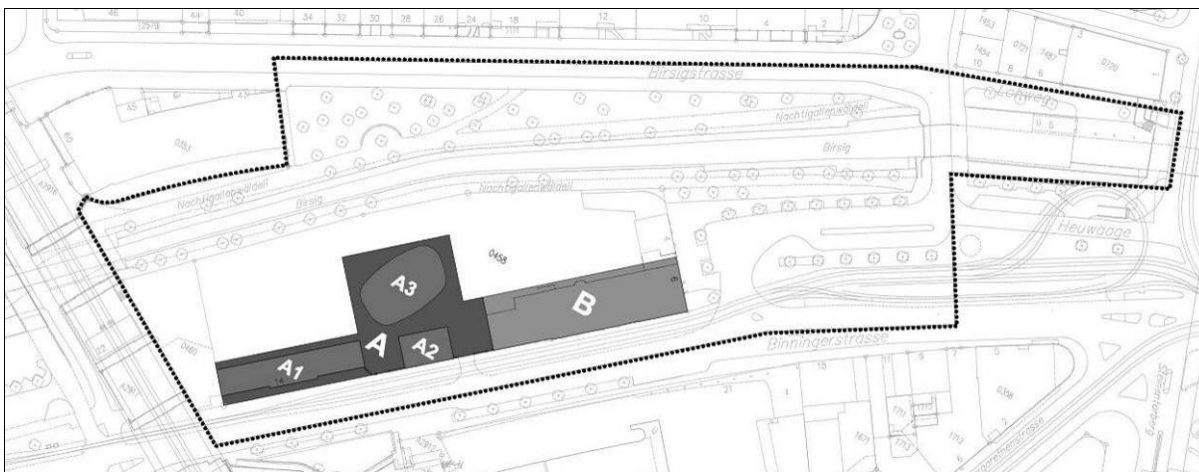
Bebauungsplan Kuppel / Gaswerk, Plan Nr. 13'351. (Kein Massstab, Plan nicht genordet)
